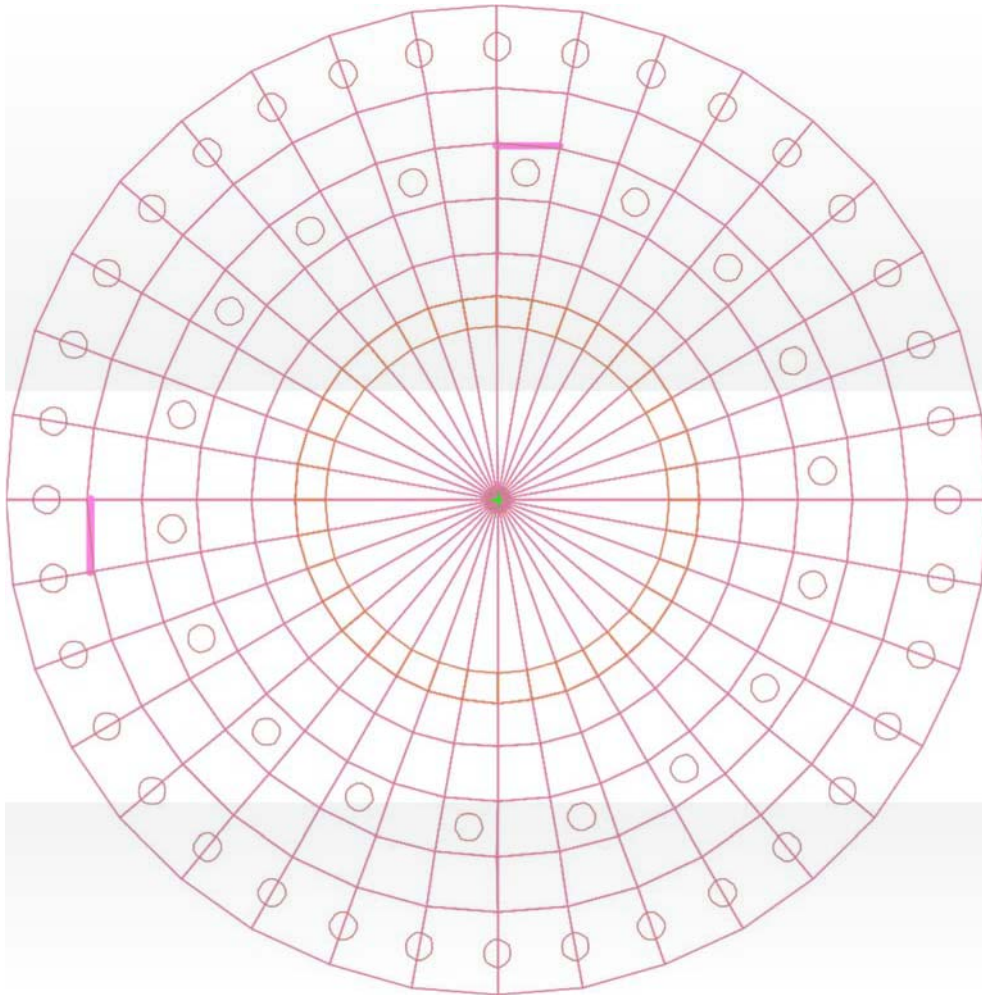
Pianta Plinto di fondazione (a filo di ferro)
